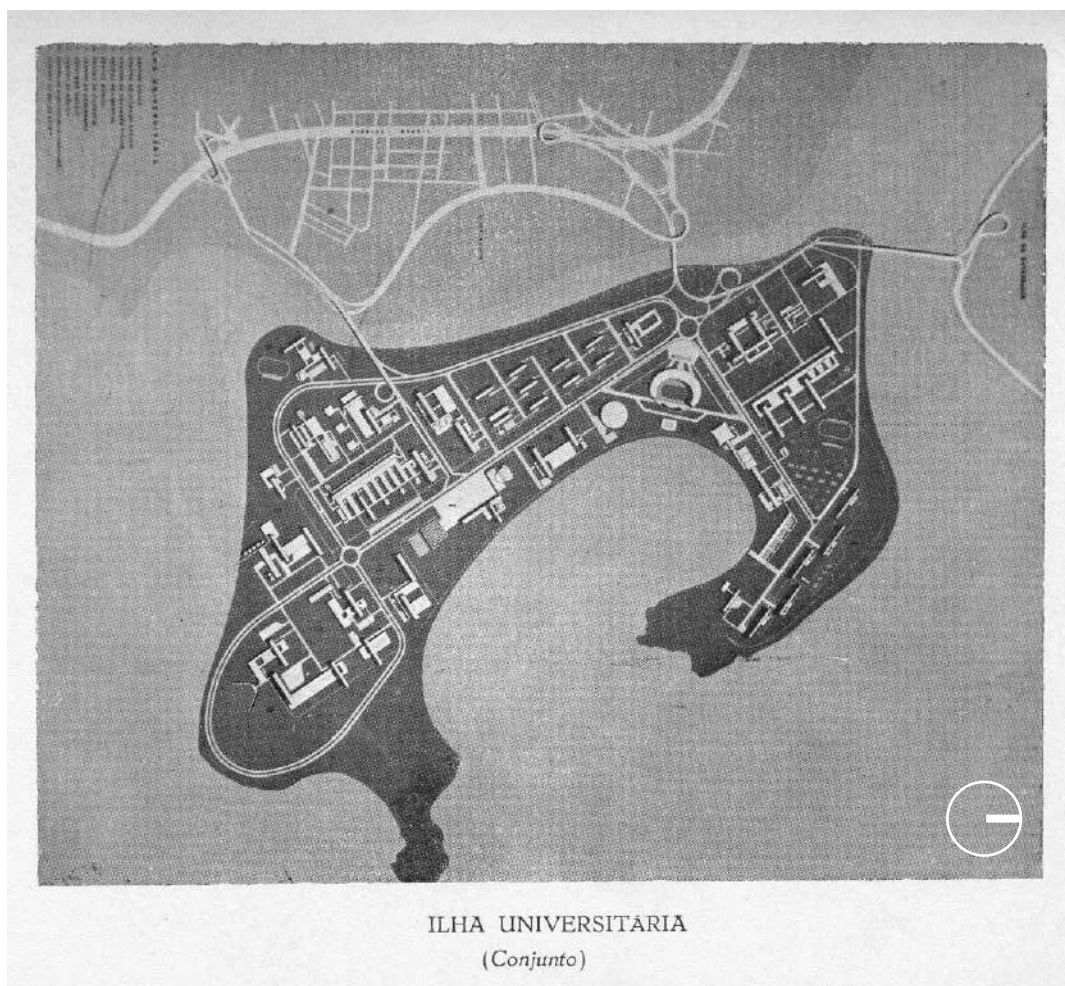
Plano Geral da CIDUNI projetado por Jorge Moreira, parcialmente executado e modificado posteriormente. Fonte: NPD-FAU.
